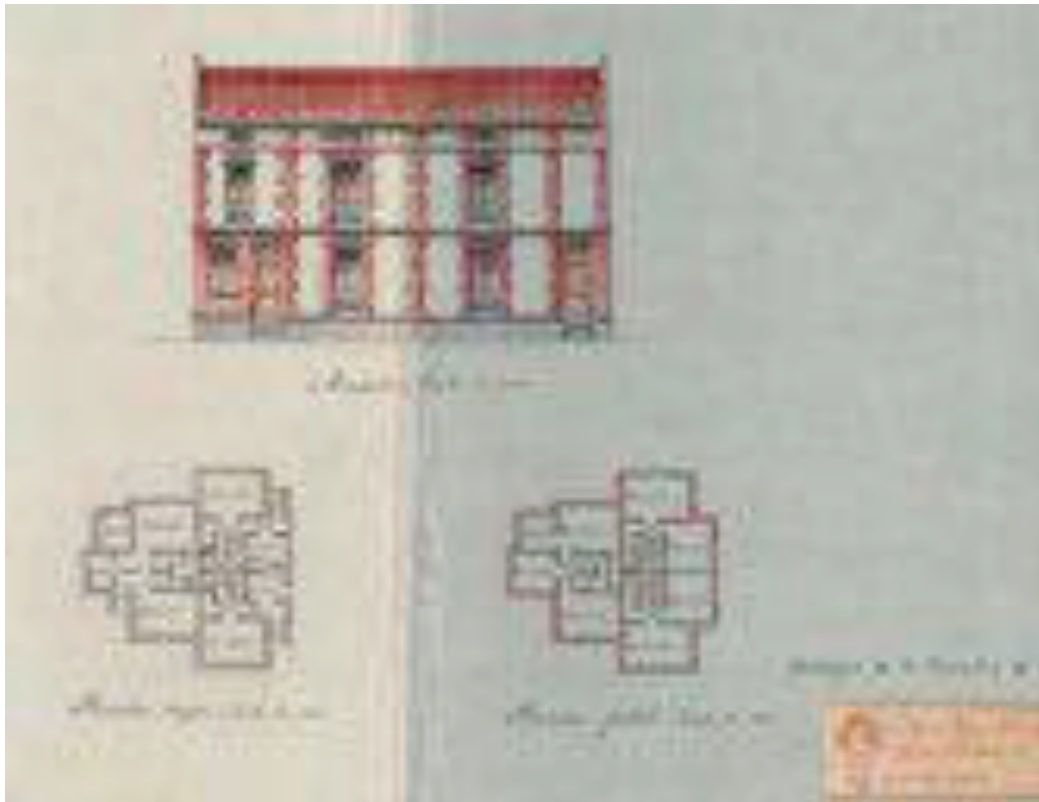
Plano de la Casa aislada nº25. 31 de diciembre de 1902. AMC.
